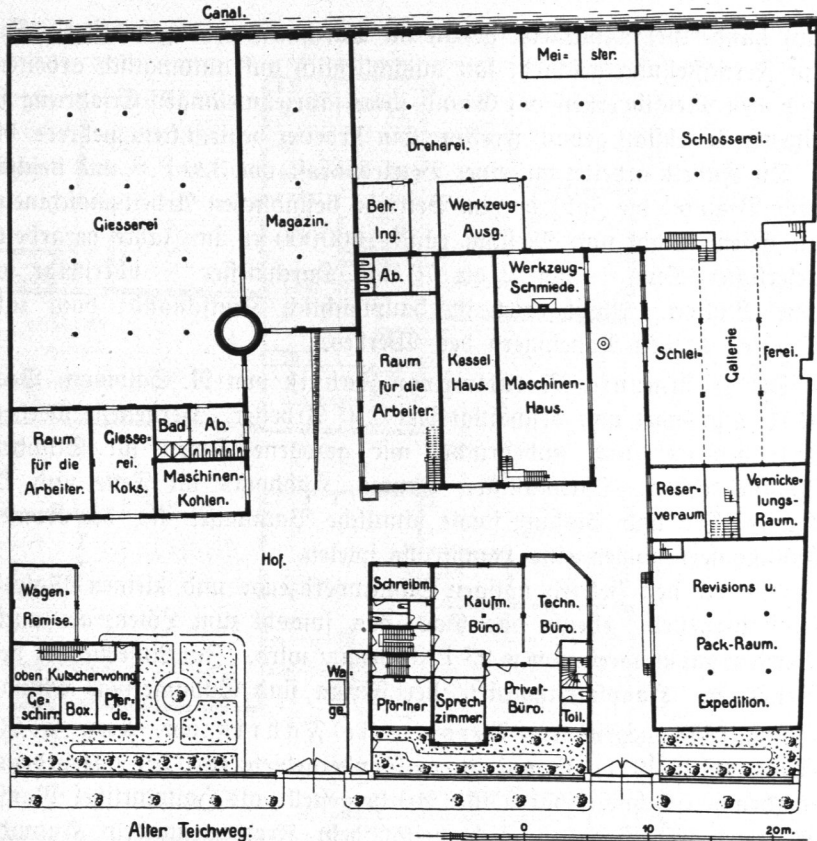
Ferdinand Müller, Tritonwerke, Lageplan.
